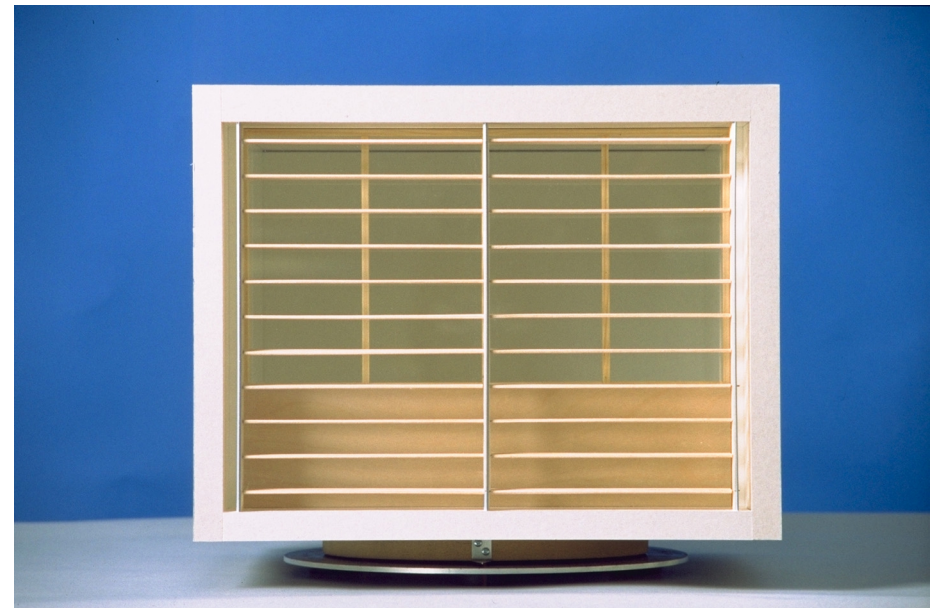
Modell der Meßeinrichtung mit Zweite-Haut-Fassade, Fassadenteilung mit Achsmaß von ca. 1,8 m
